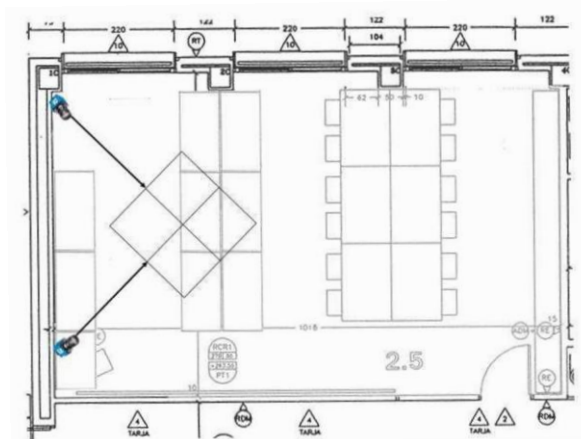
Vista en planta del laboratori. Figura extreta de [8]
